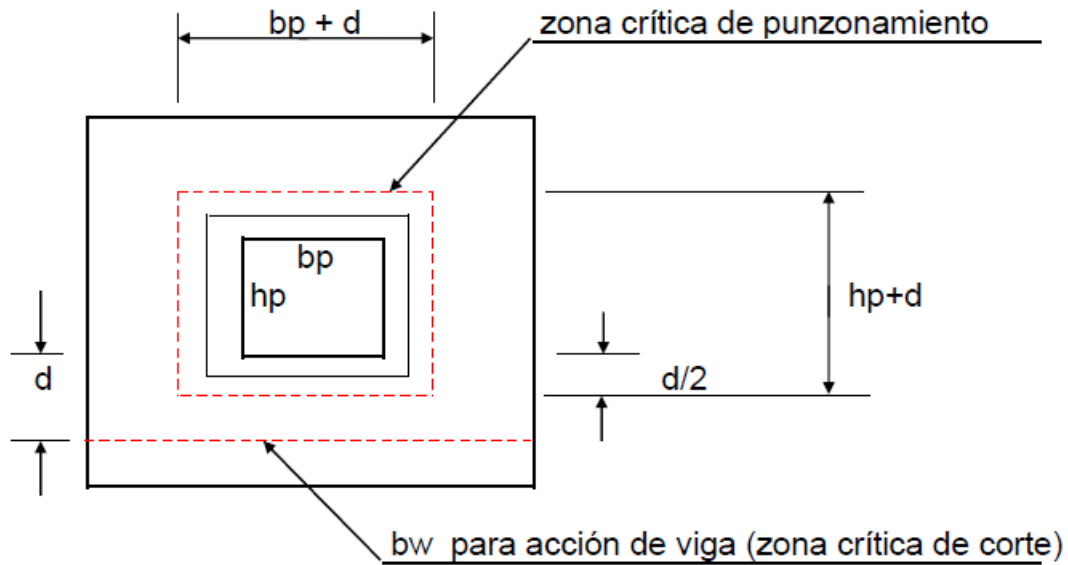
zona crítica punzonamiento y bw para ancho análisis de viga
